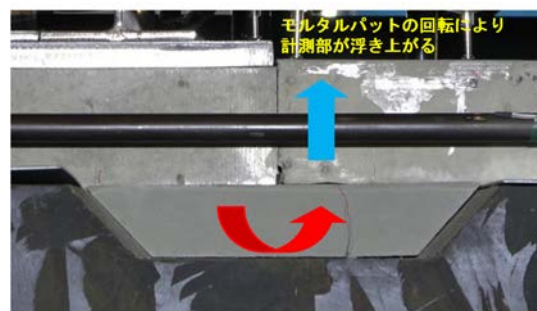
モルタルパットの回転による計測部の上向き変位の状況 (No. 2-2 供試体)
